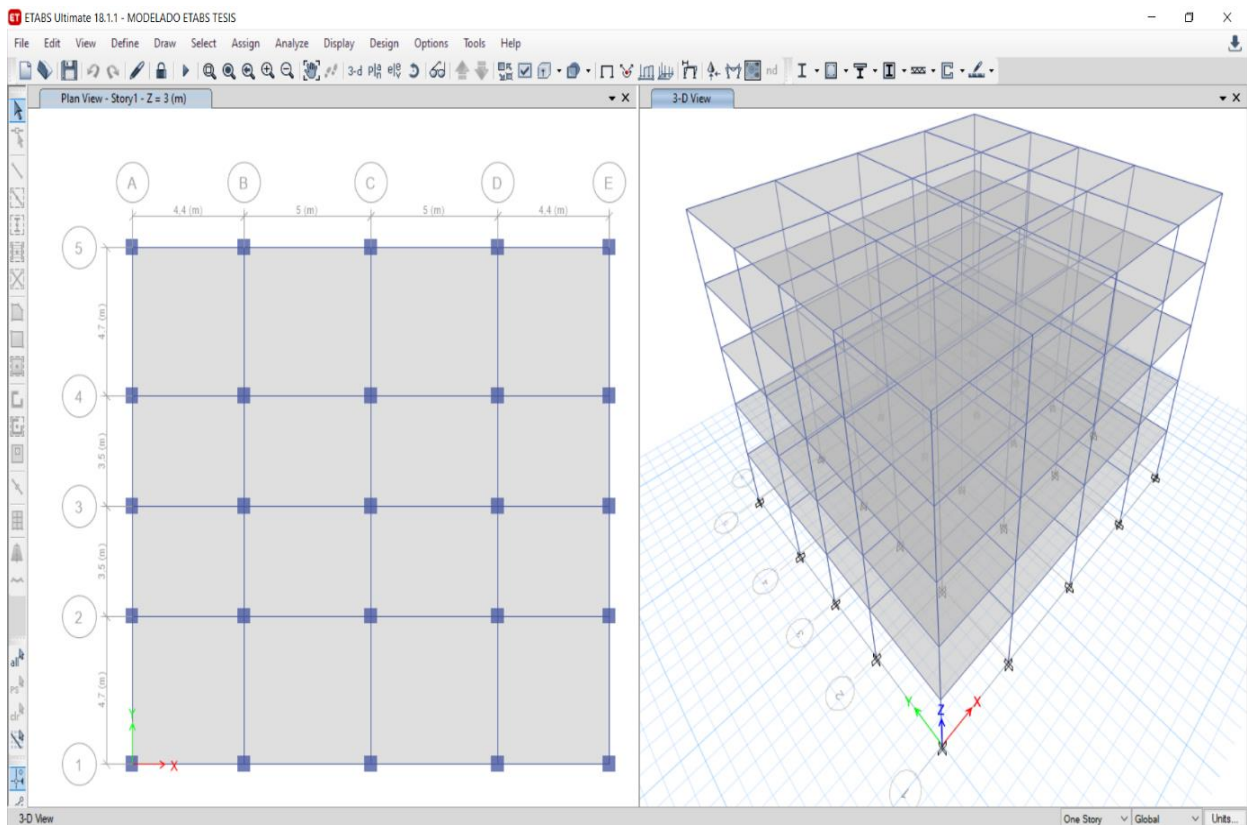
Vista de Planta y Elevación de la estructura en el software ETABS
